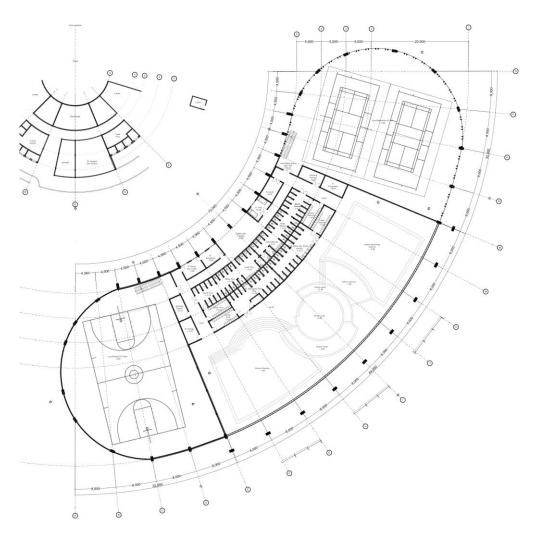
10 Denah Amphitheatre Ground dan Under Ground
